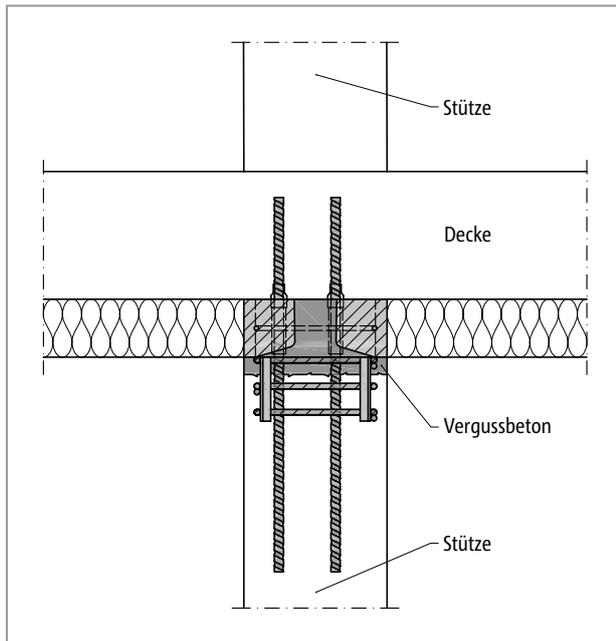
Schöck Sconnex® Typ P: Anschluss einer Innenstütze an die darüberliegende Decke
